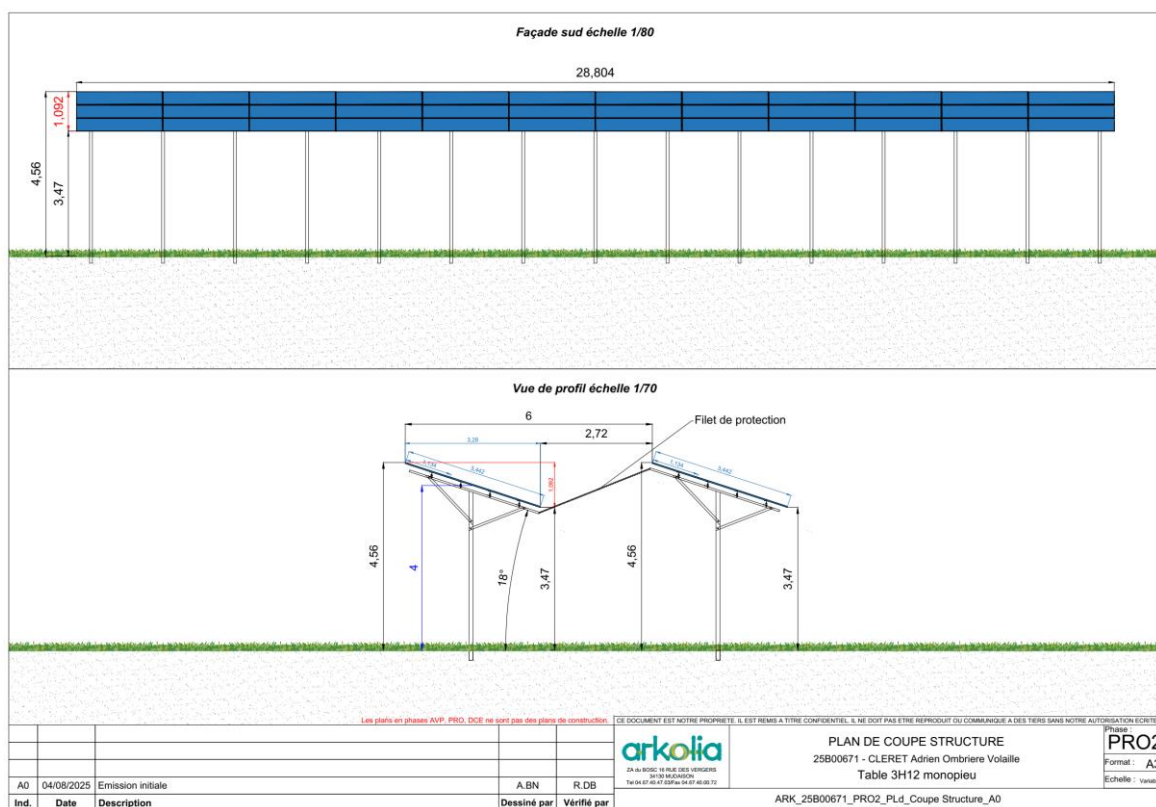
Plan de coupe d'une ombrière (= 2 tables reliées entre-elles)
